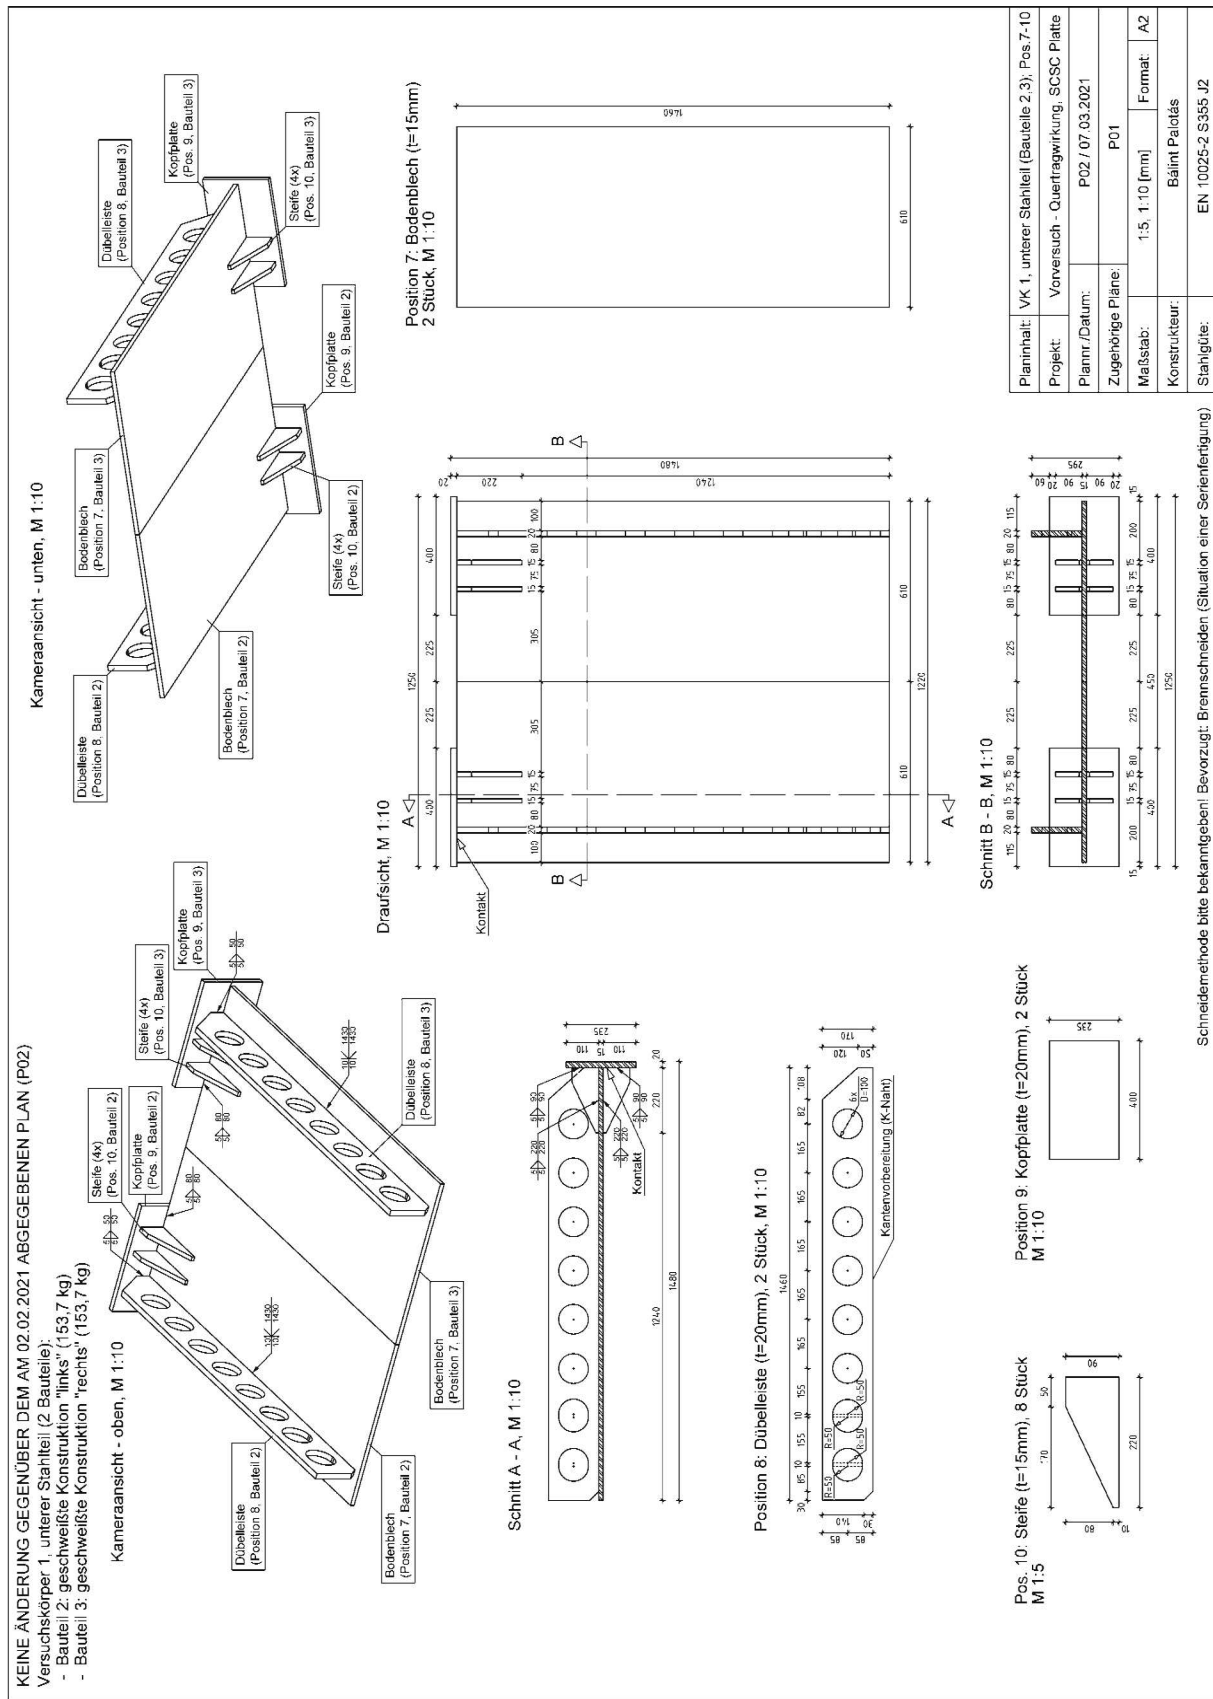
Werkstattplan-P02 des Versuchskörpertyps-VK1; Quelle: TU Wien Institut für Tragkonstruktionen Forschungsbereich für Stahlbau
